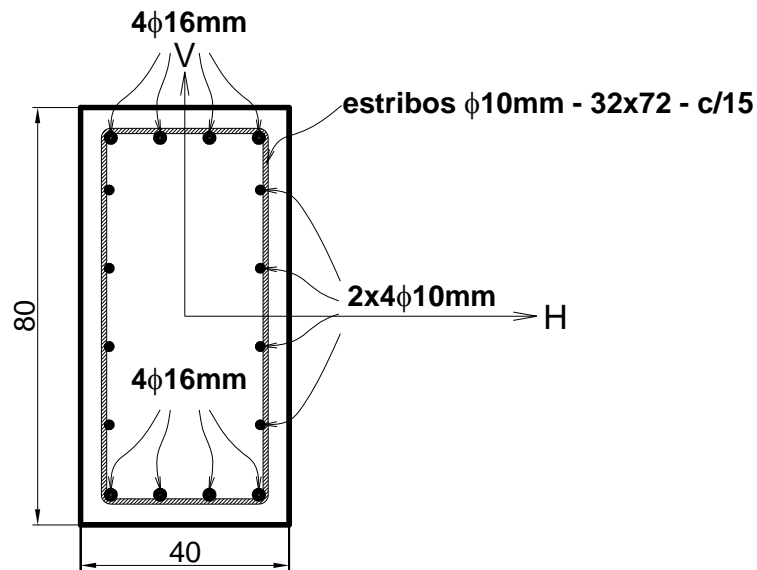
Seção transversal típica das vigas de ligação das cabeças das estacas (dimensões em centímetros)
